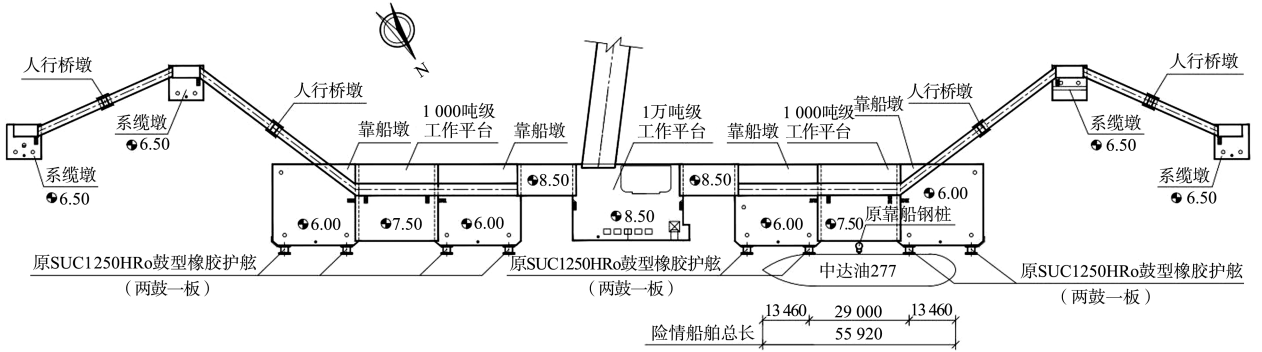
“中达油 277” 靠泊平面布置 (高程: m; 尺寸: mm)
